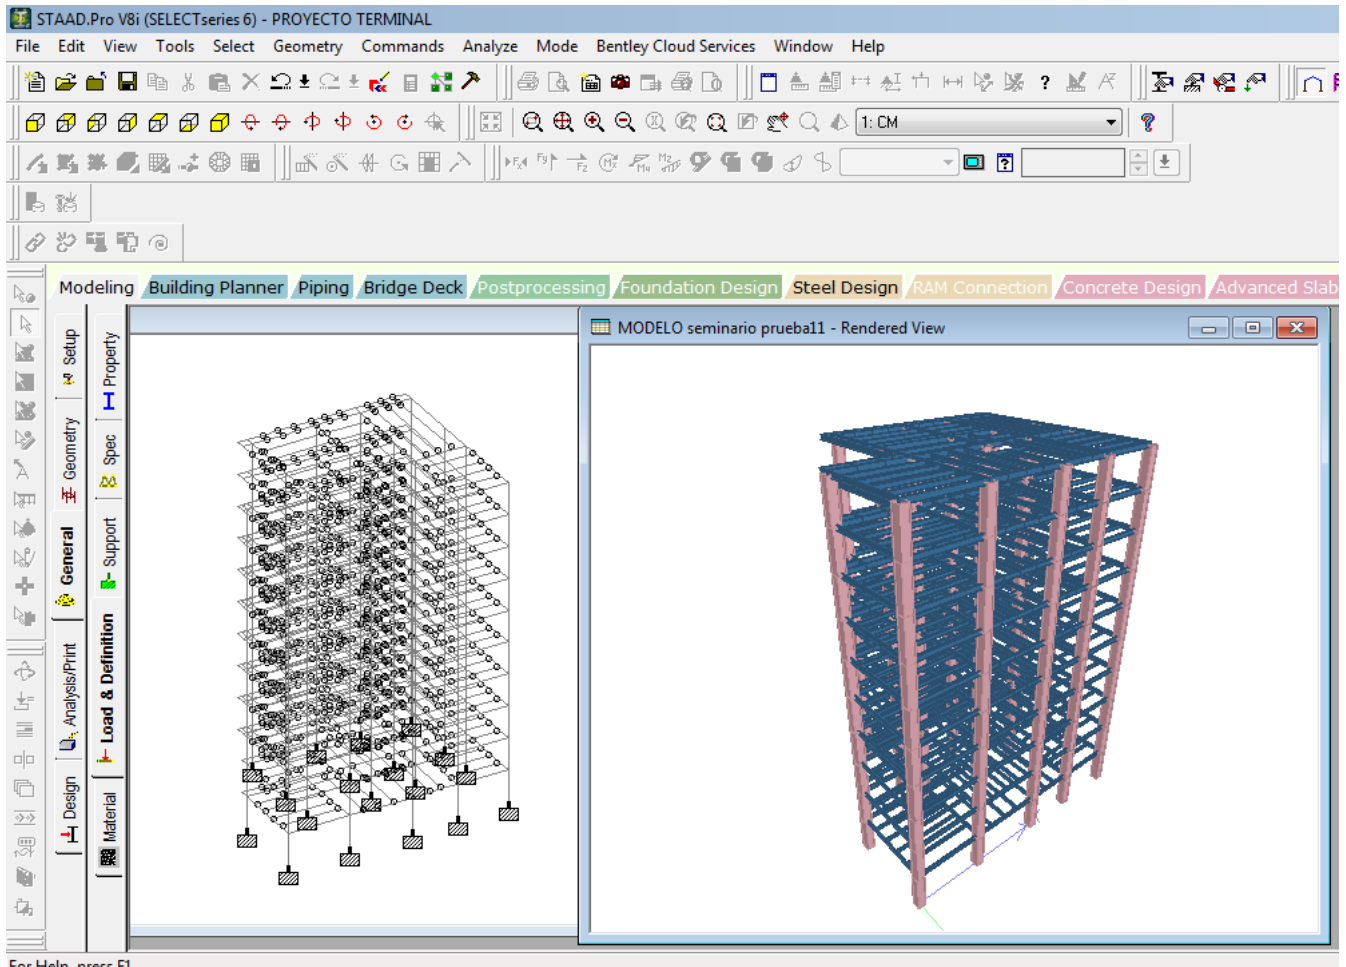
Modelo estructural en Staad Pro V8i.
